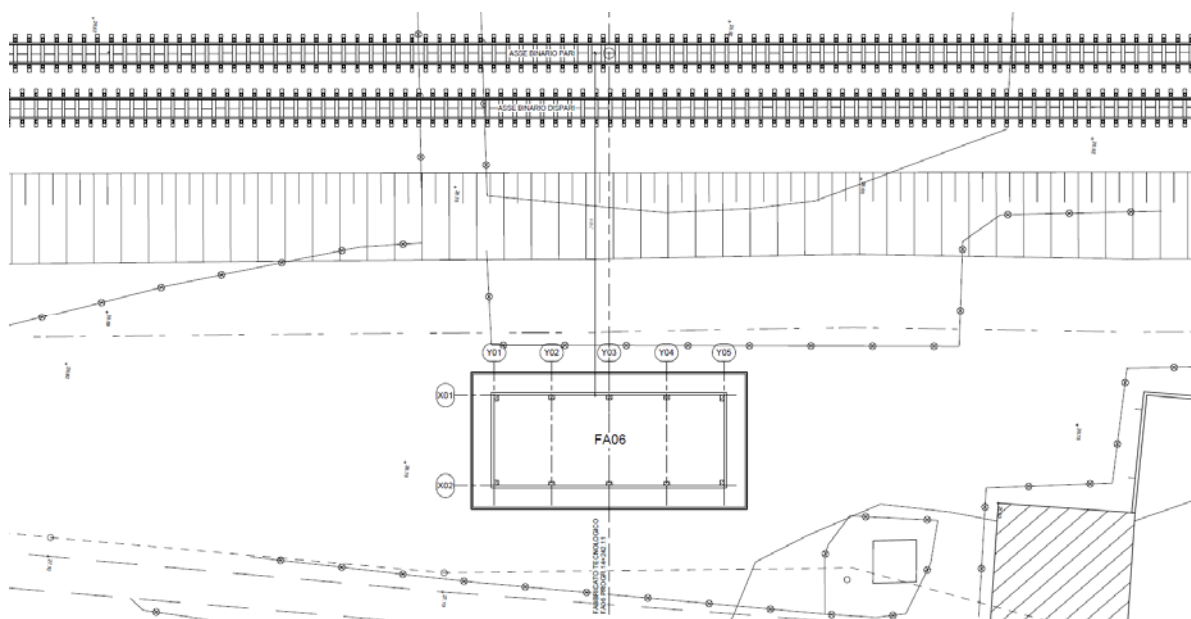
Stralcio planimetrico dell'area di intervento – Ubicazione del piazzale del fabbricato tecnologico FA.06
